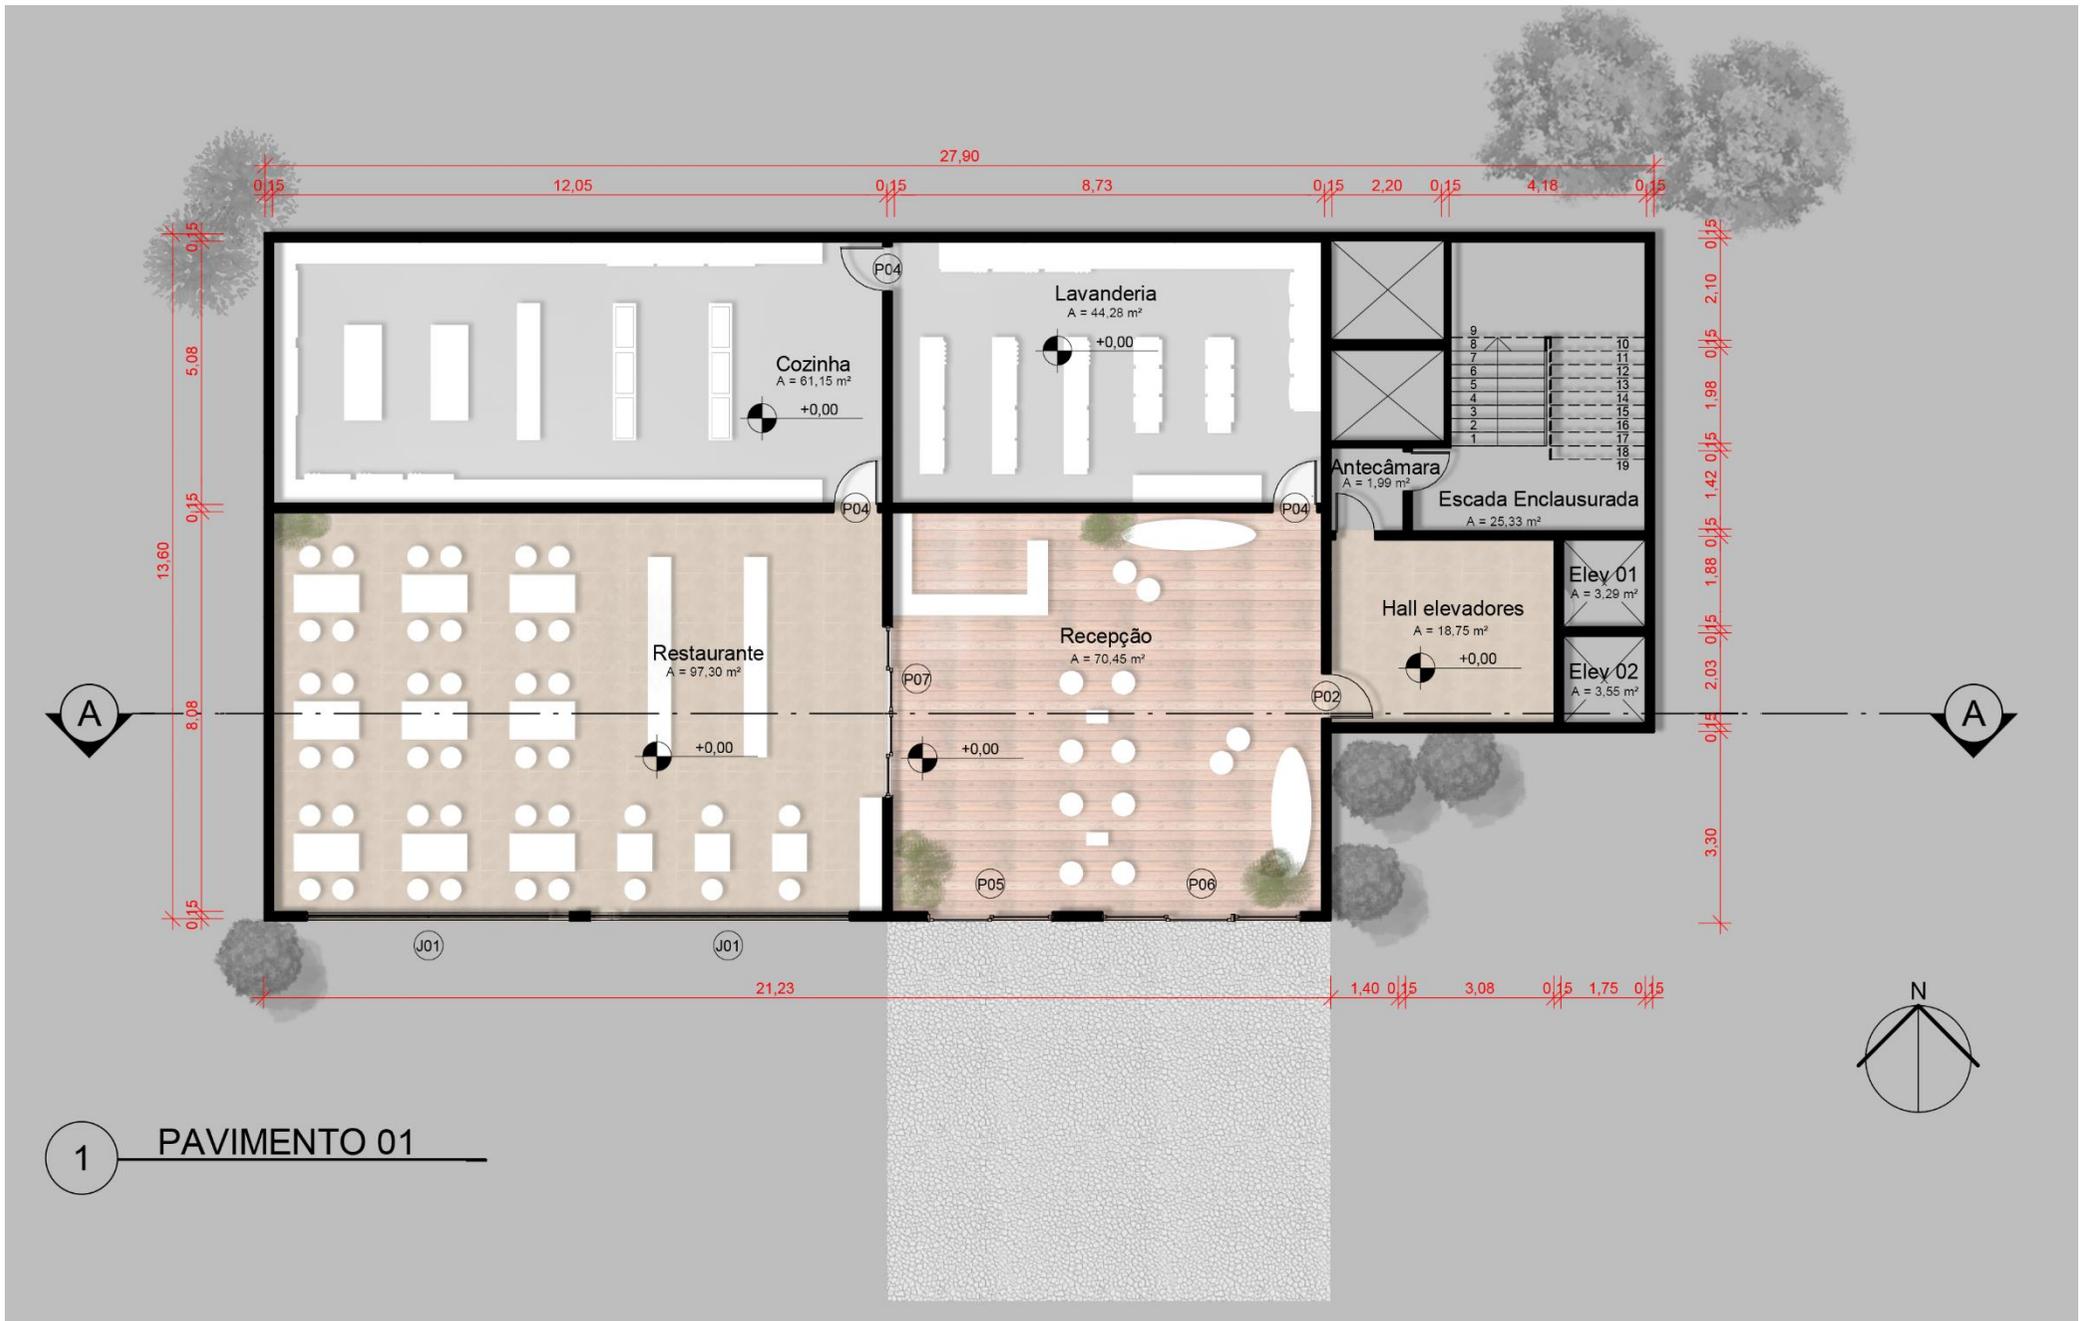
Planta baixa do primeiro pavimento (térreo) da edificação exemplo
